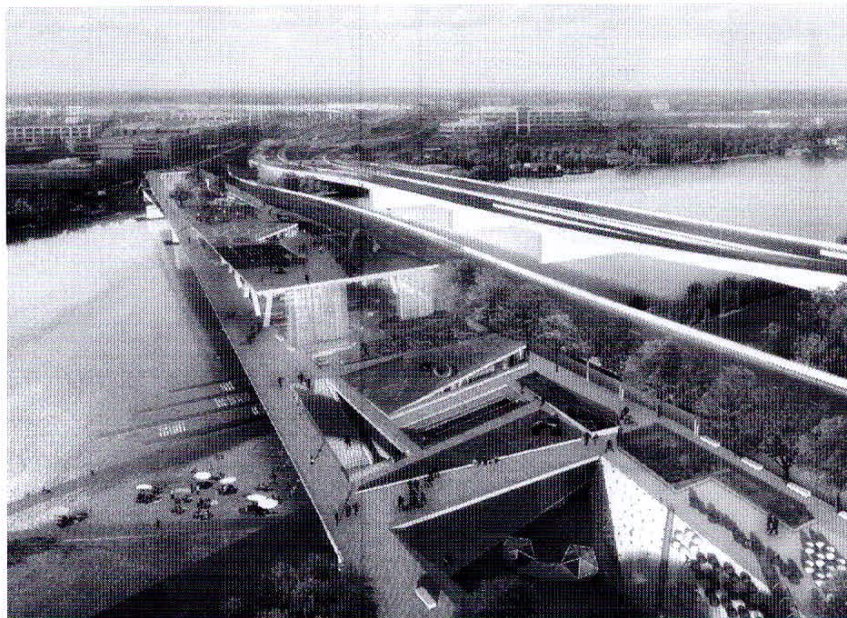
Projeto para *Street Bridge Park* – vista aérea
